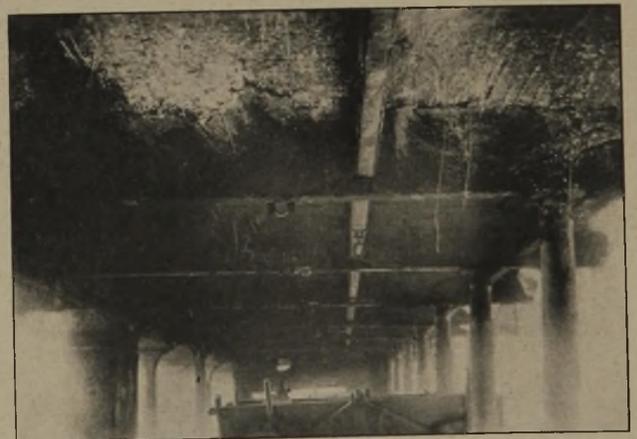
Beschädigung der Eisenbetondecke im alten Ofenhaus
